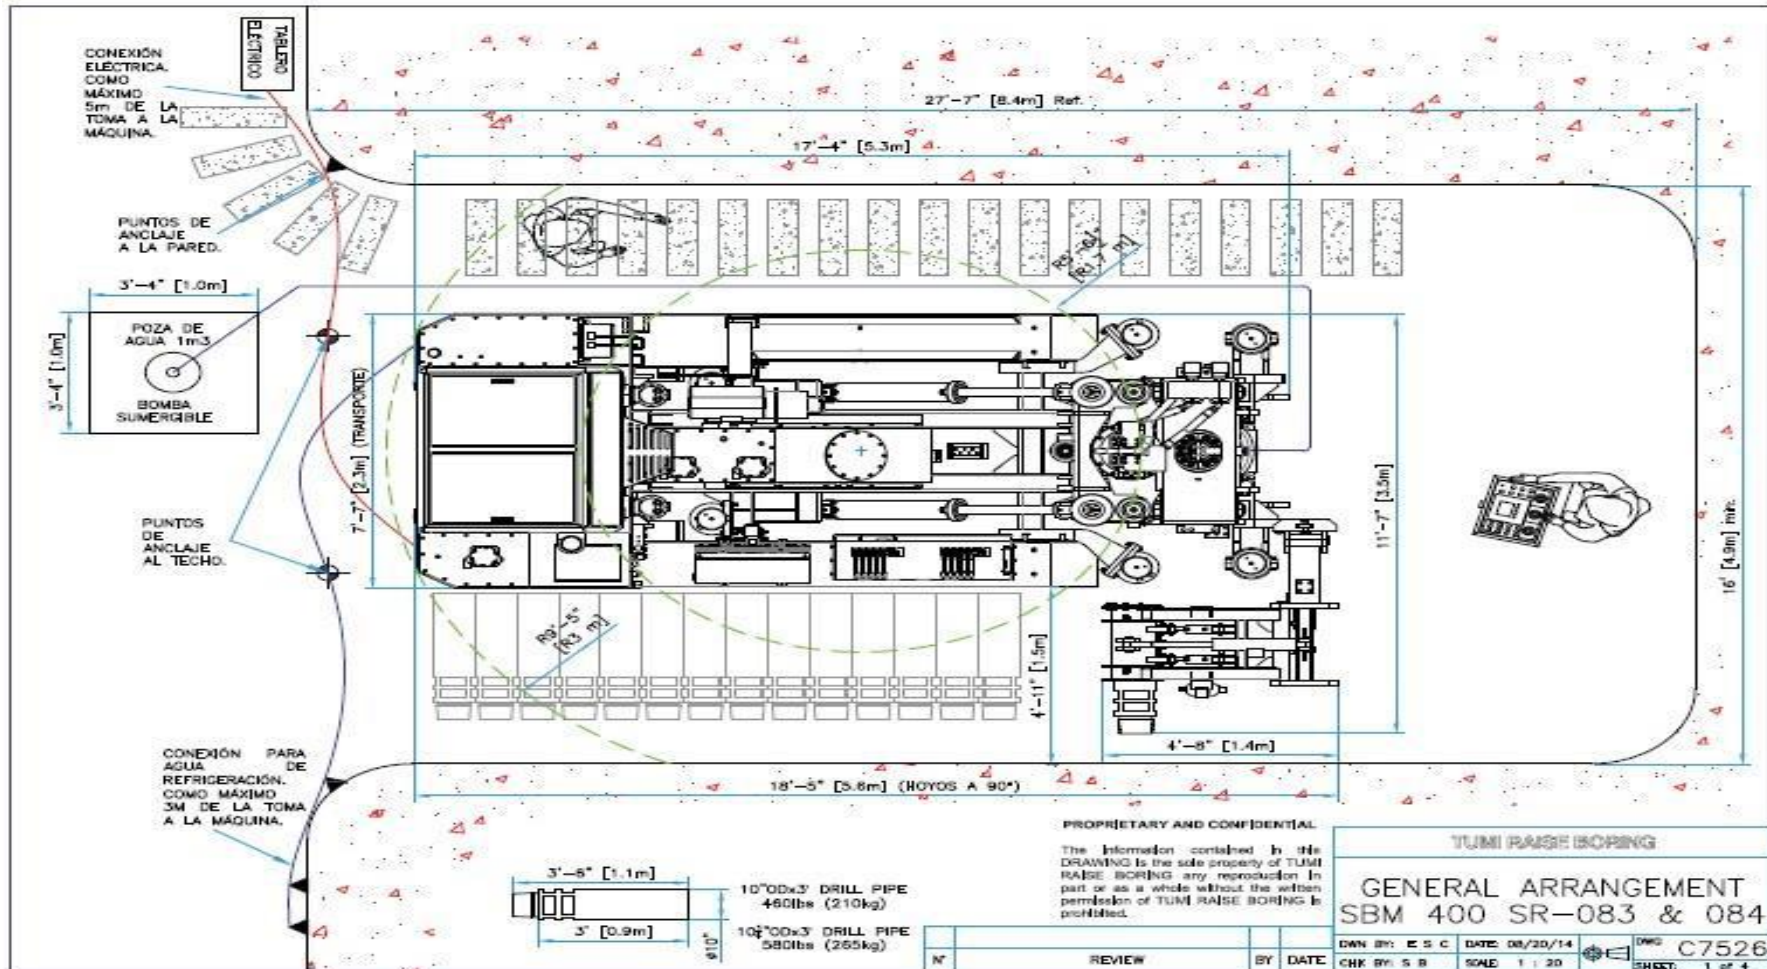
Estándar de cámara adjunto – plano vista en planta.
